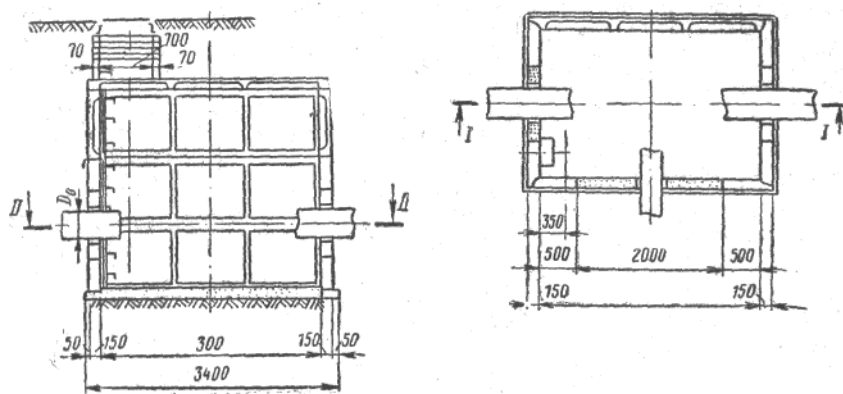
Збірний залізобетонний колодязь прямокутного типу.
